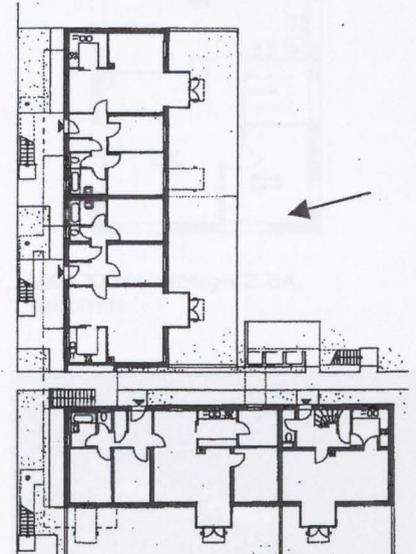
Tannhof 2, Riess 1988, Grundrisse
